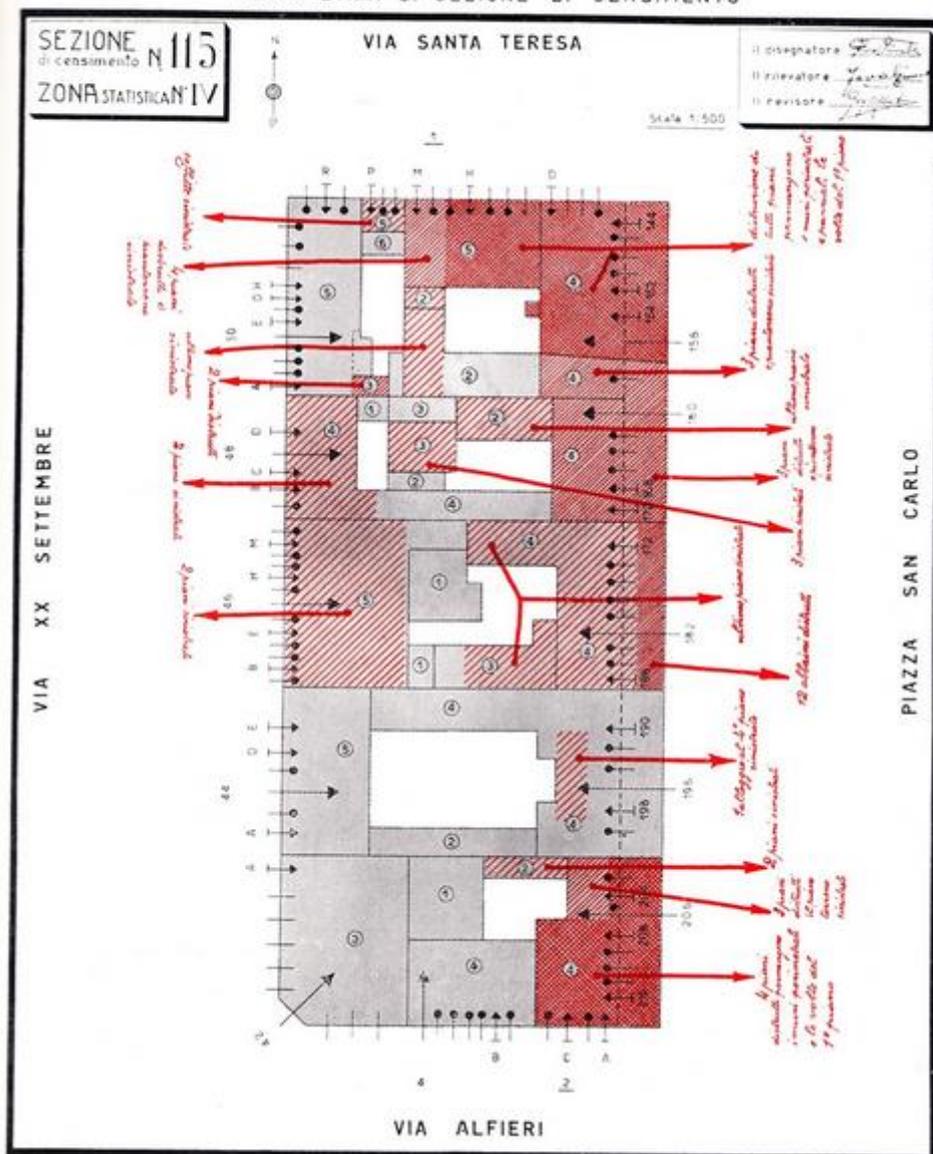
Rilevazione dei danni edilizi. Planimetria di sezione di censimento.
